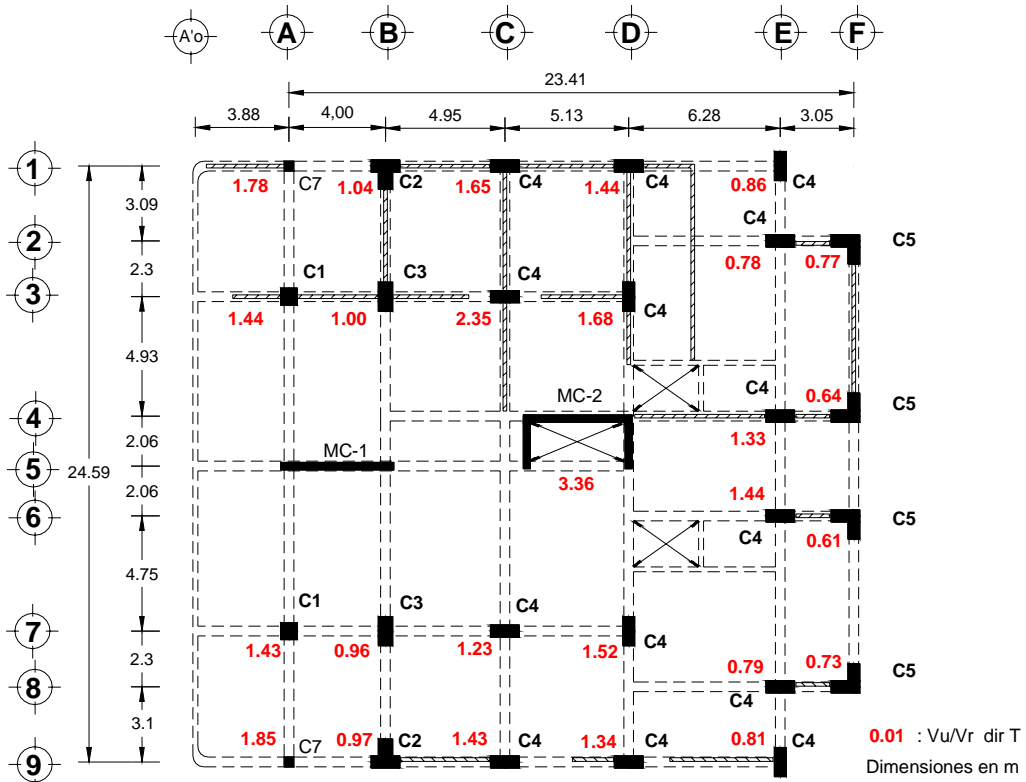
Relaciones entre el cortante último y el cortante resistente en las columnas y muros de concreto de planta baja, para un análisis con Q=4
